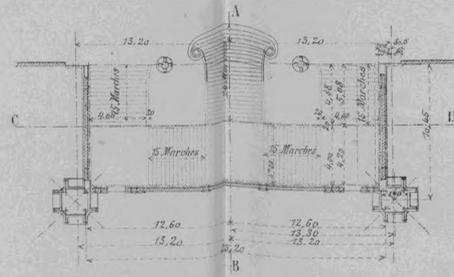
Plan de l'escalier (Côté Ecole Militaire)
